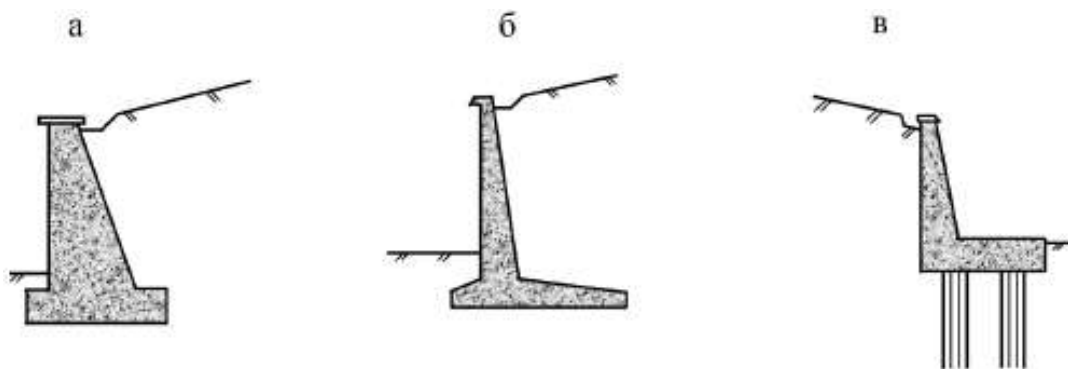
Схема подпорных стенок на естественном основании и на сваях: *а* – монолитная; *б* – сборная; *в* – на свайном фундаменте
